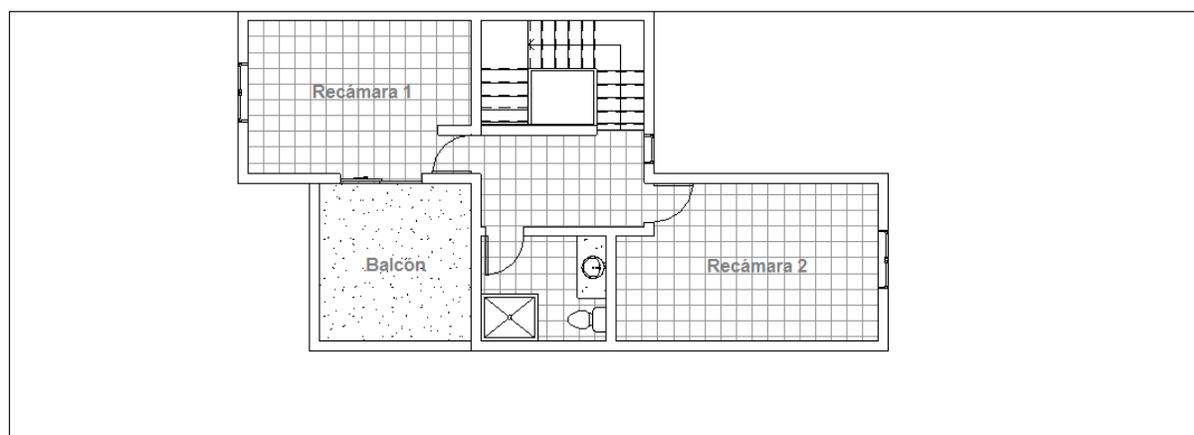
Croquis de vivienda tipo media, en planta alta
